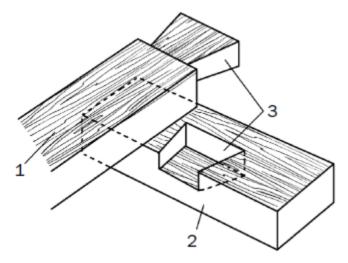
Выполнение врубки балки перекрытия: 1 – балка перекрытия; 2 – верхний венец; 3 – соединение «глухой сковородень»
